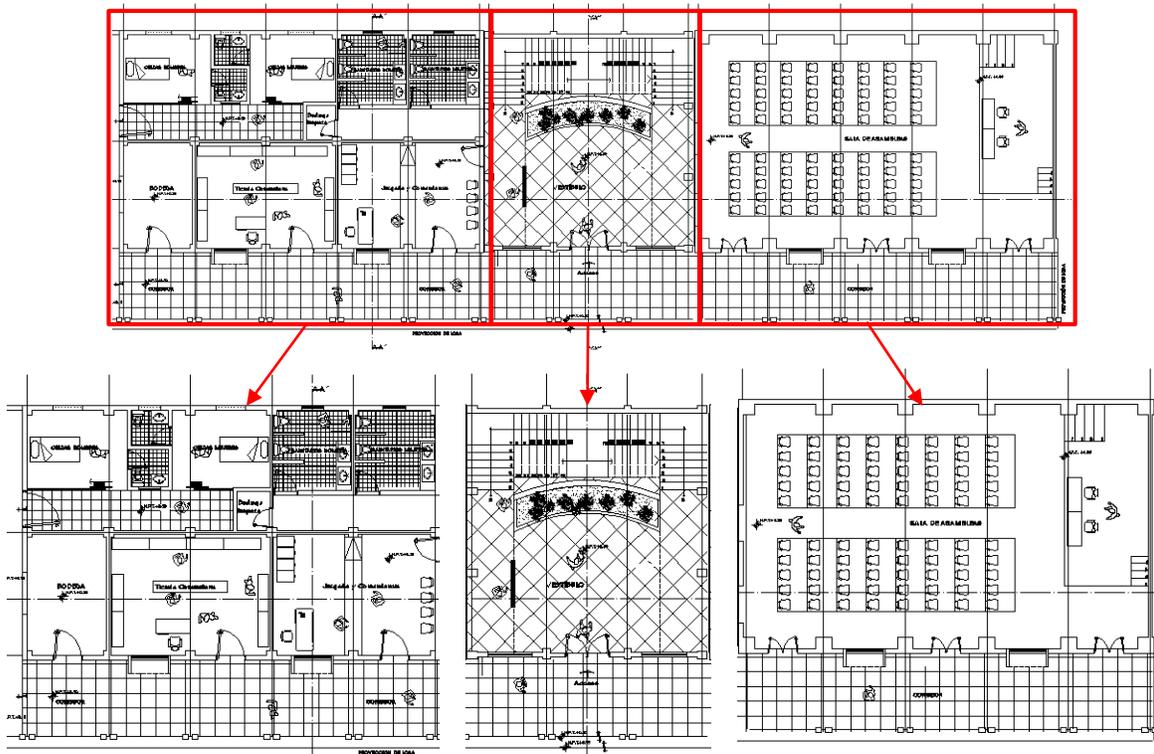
Israel Hdez. División del edificio en tres segmentos separados por juntas constructivas.
